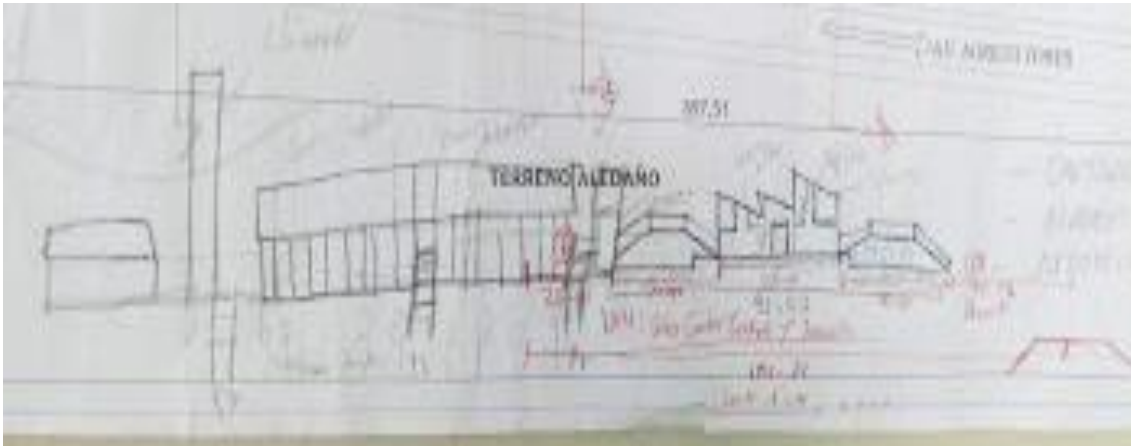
Foto Fachada y corte transversal, Fuente: elaboración propia.
